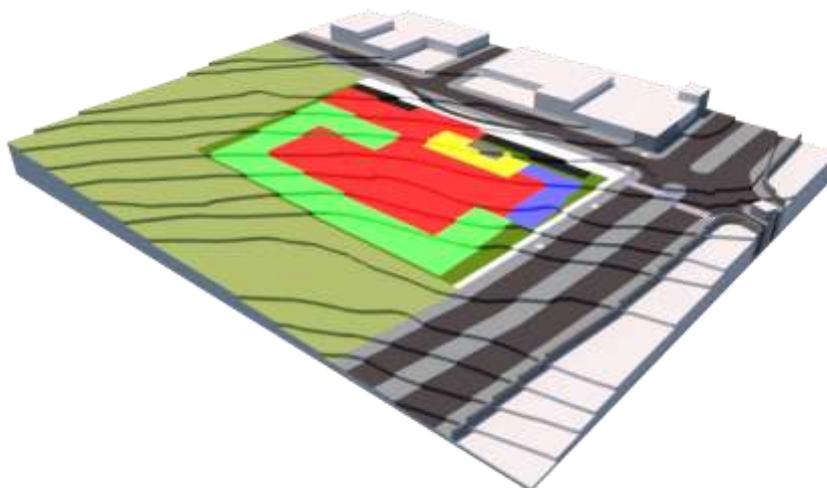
Plano Massa terreno sem alteração juntamente com o Porte Cochère
